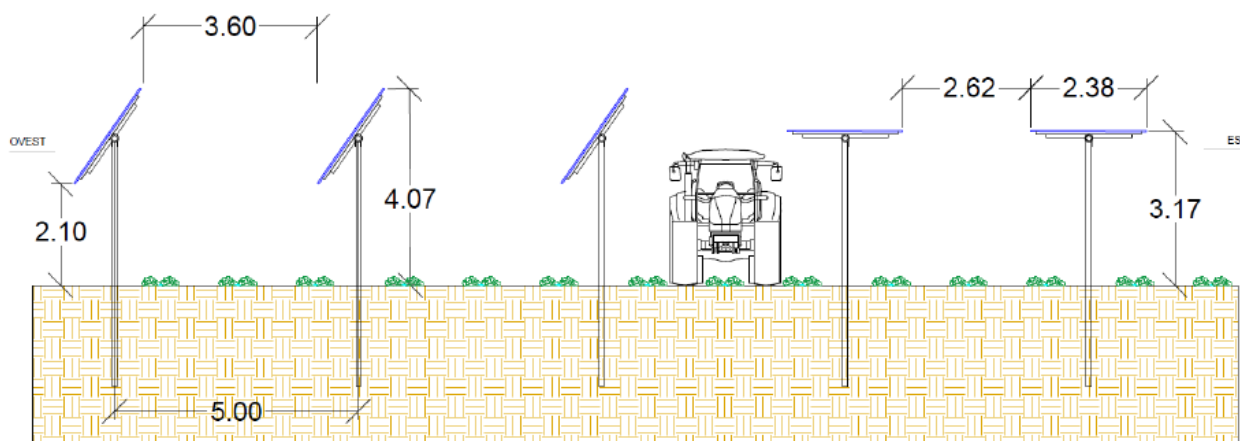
Sezione impianto che attesta l'altezza minima.
